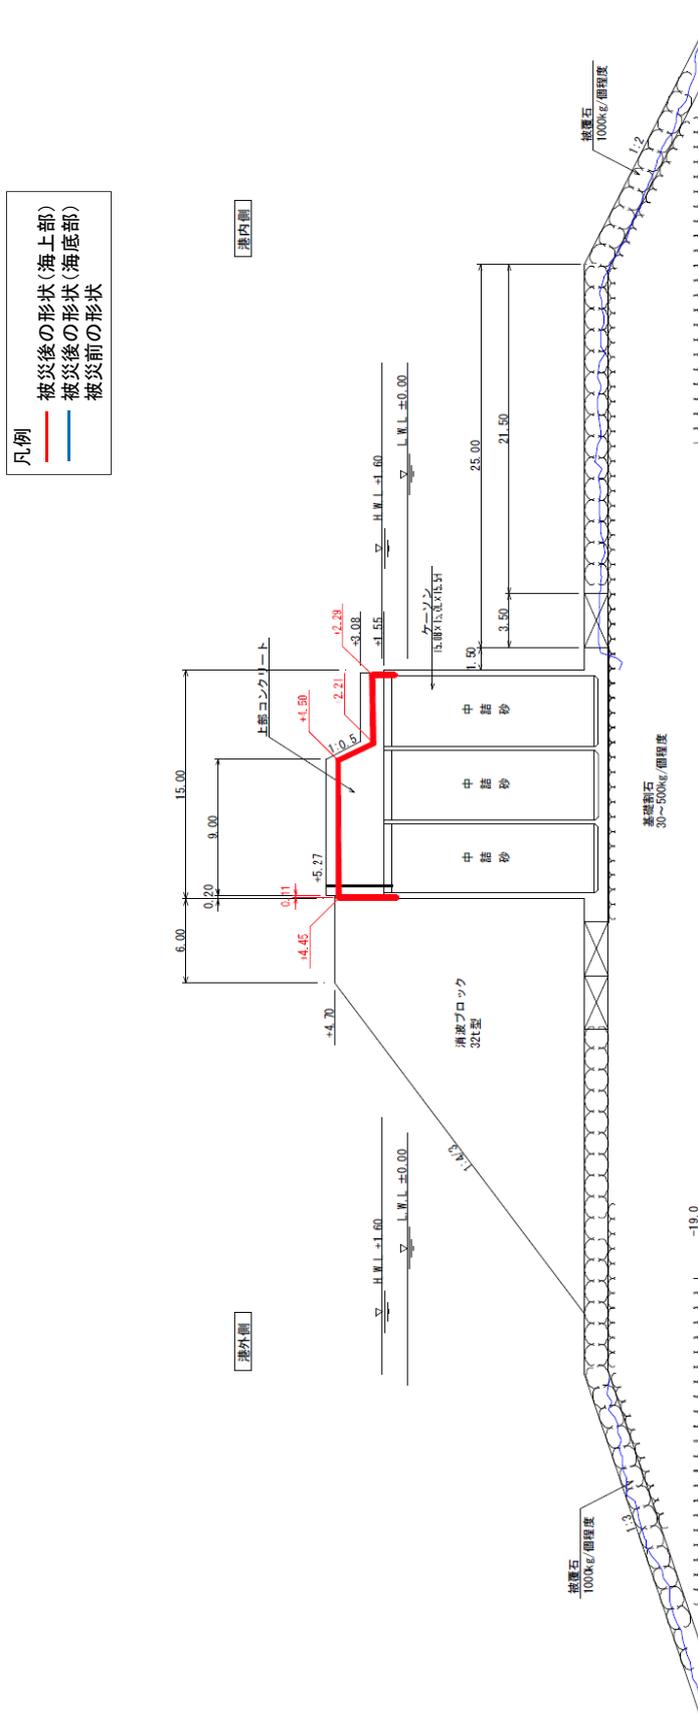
仙台港区\_外港地区\_沖防波堤の断面図 (図-3.12.10 の B-B'断面, 被災後)
